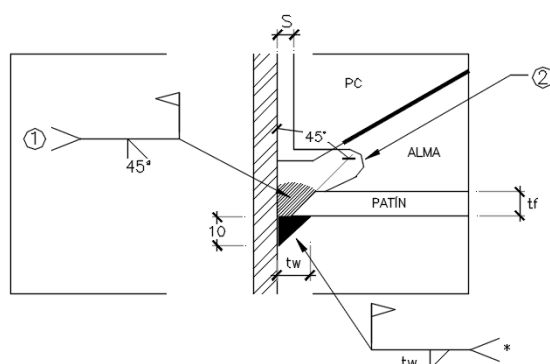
Detalle de soldadura viga-columna del patín inferior
